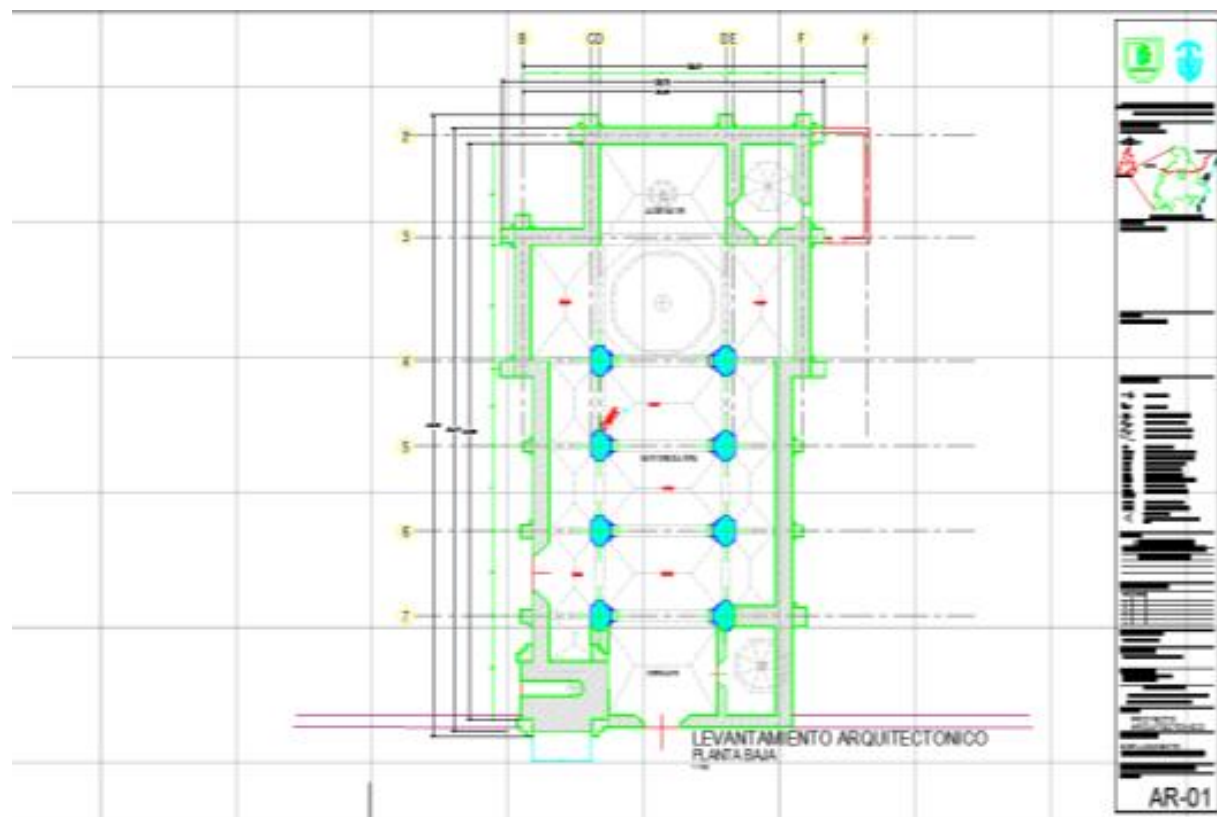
Planta arquitectónica nivel +101.00 de la Parroquia,
